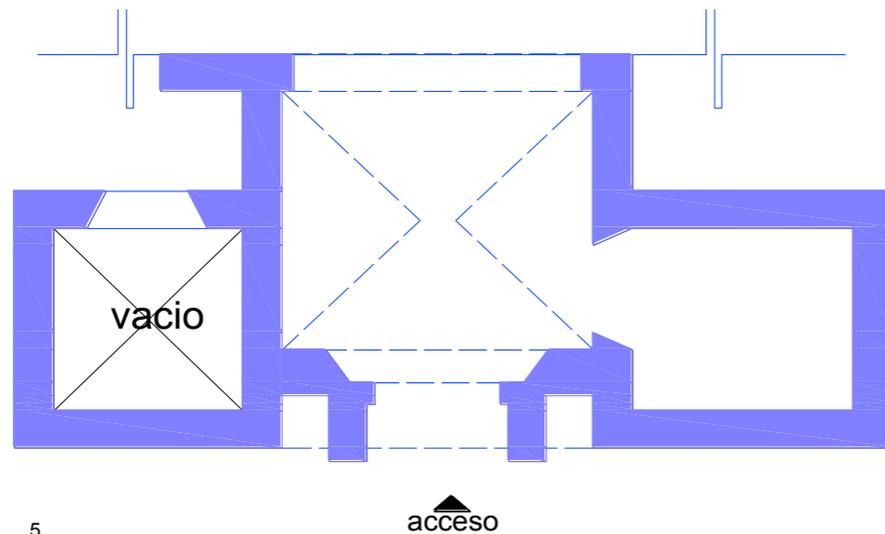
Planta de la fachada del Templo del Señor de la Misericordia
